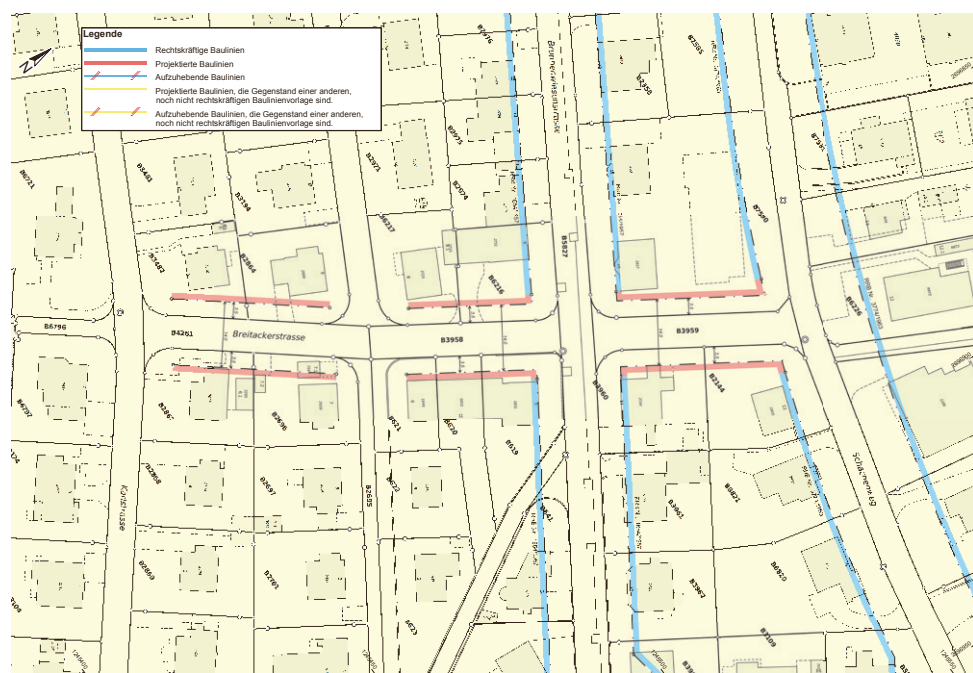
Baulinienprojekt gemäss Situationsplan vom 9. September 2019: Die projektierten Baulinien, über die abgestimmt wird, sind in Rot dargestellt. Die Pfeile zeigen die räumlichen Dimensionen (z. B. Baulinienbreite 14,0 m). Der Plan ist nicht nach Norden ausgerichtet.
